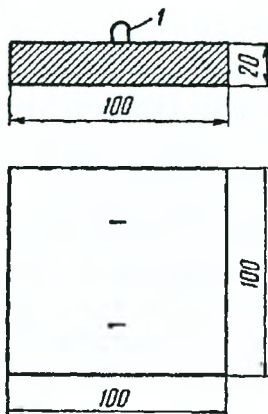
Бетонная плита размером 1,0х1,0х0,20 м: 1 – монтажная петля
